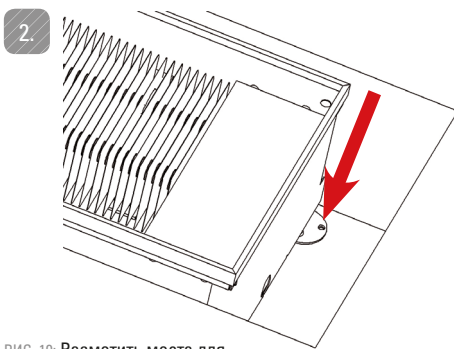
Разметить места для сверления отверстий для крепления пята, и конвектор вынуть.
